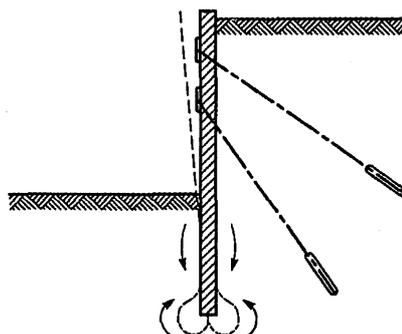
Exemple de mode limite pour la rupture verticale des écrans de soutènement
